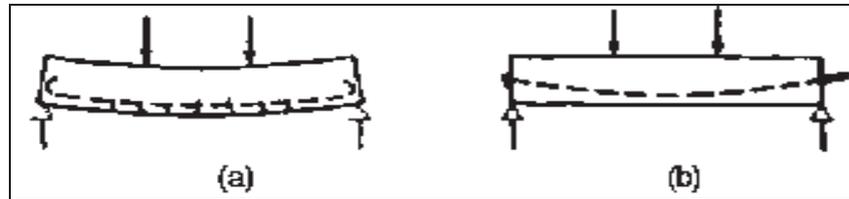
Deformación y agrietamiento en vigas de: (a) Concreto reforzado y (b) Concreto presforzado [3].
